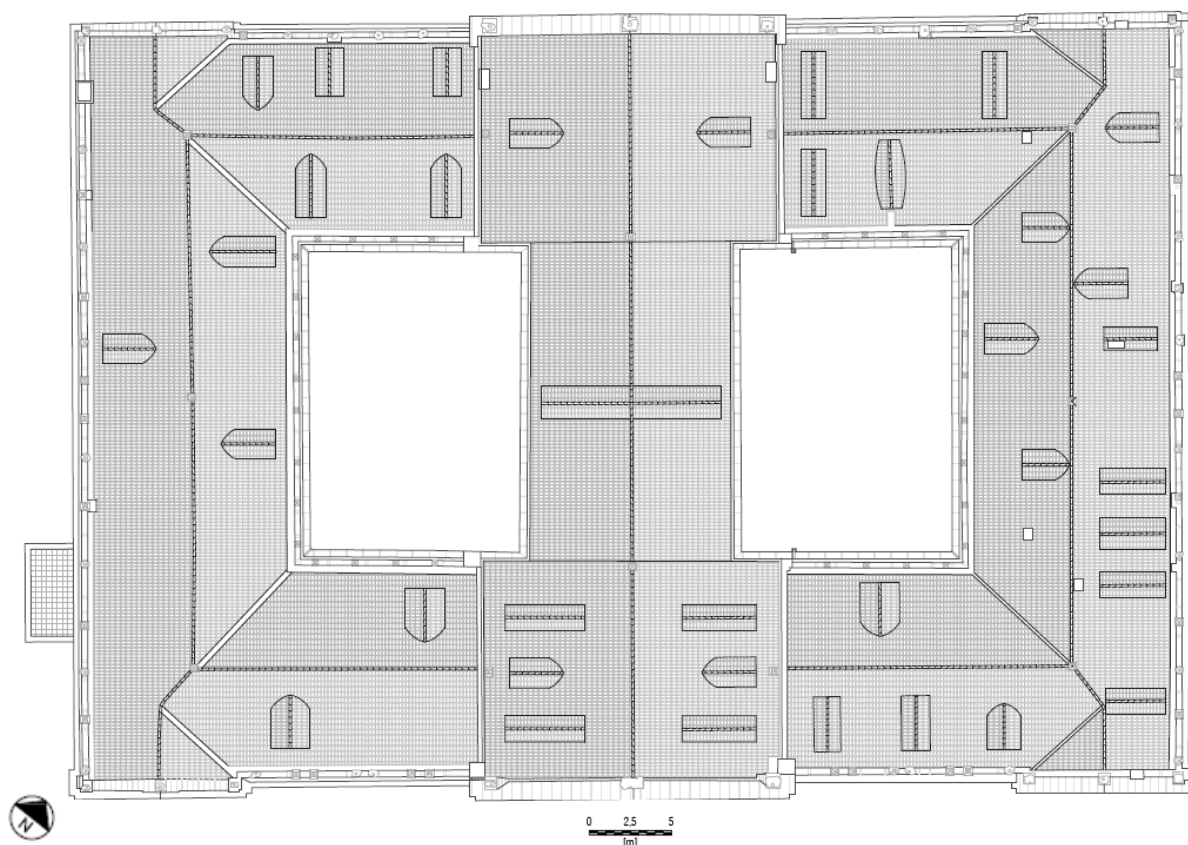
Planimetria di Villa Pisani – Pianta della copertura.
